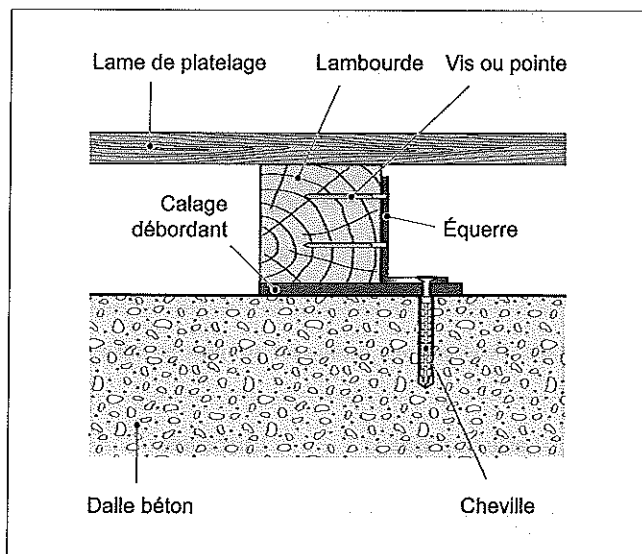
Fixation d'un platelage avec lambourdes sur support en béton - Fixation directe par chevilles [source : DTU 51.4].
